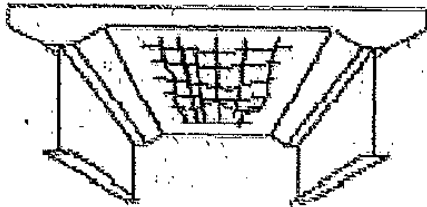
道路橋 RC 床版のひび割れ損傷過程
